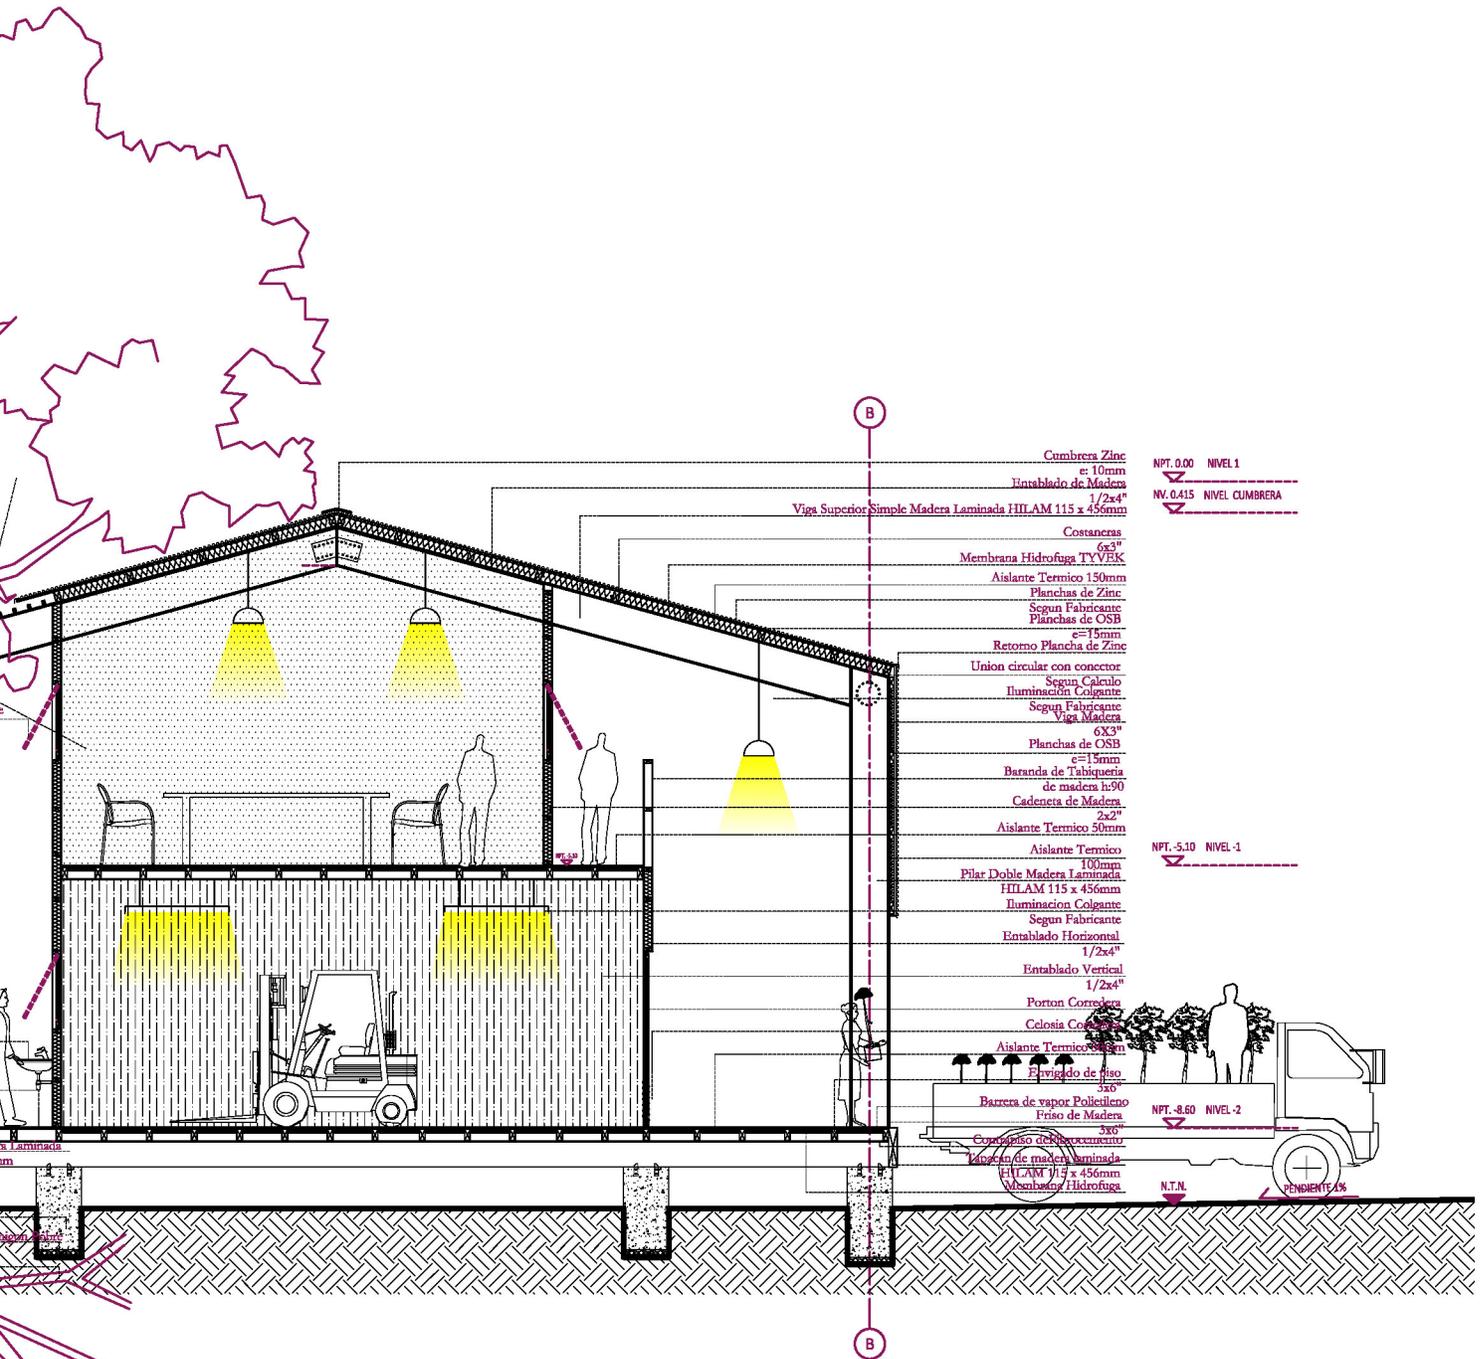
Planimetría ESCANTILLON ESC. 1:75
